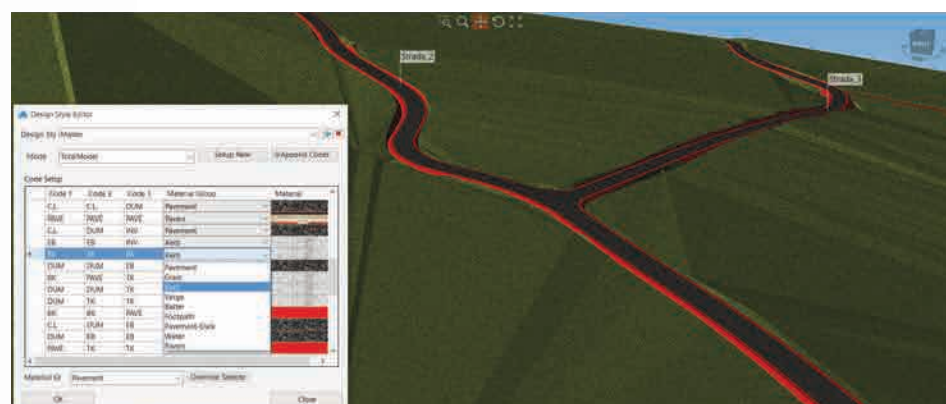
Atribuirea tipurilor de „materiale” elementelor din profilul transversal
